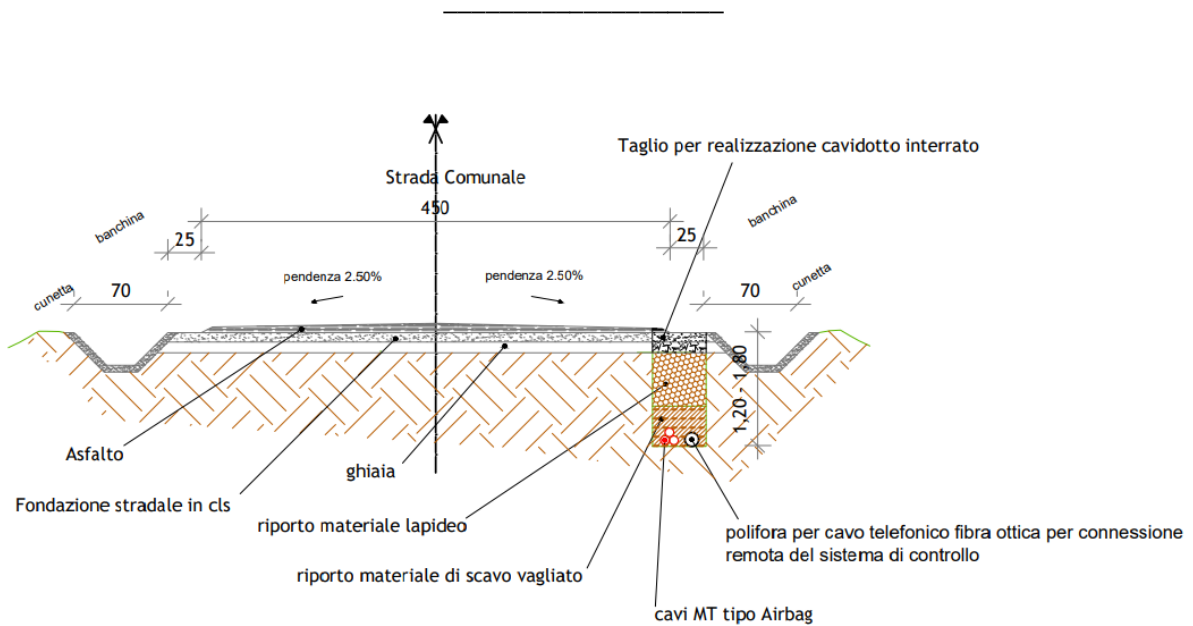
Sezione tipo - Passaggio di cavidotto su strada comunale esistente
